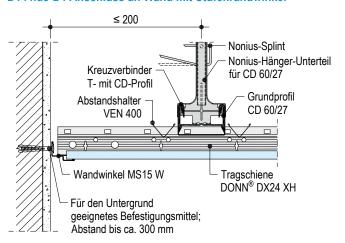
de-A1 Anschluss an Wand mit Stufenrandwinkel
